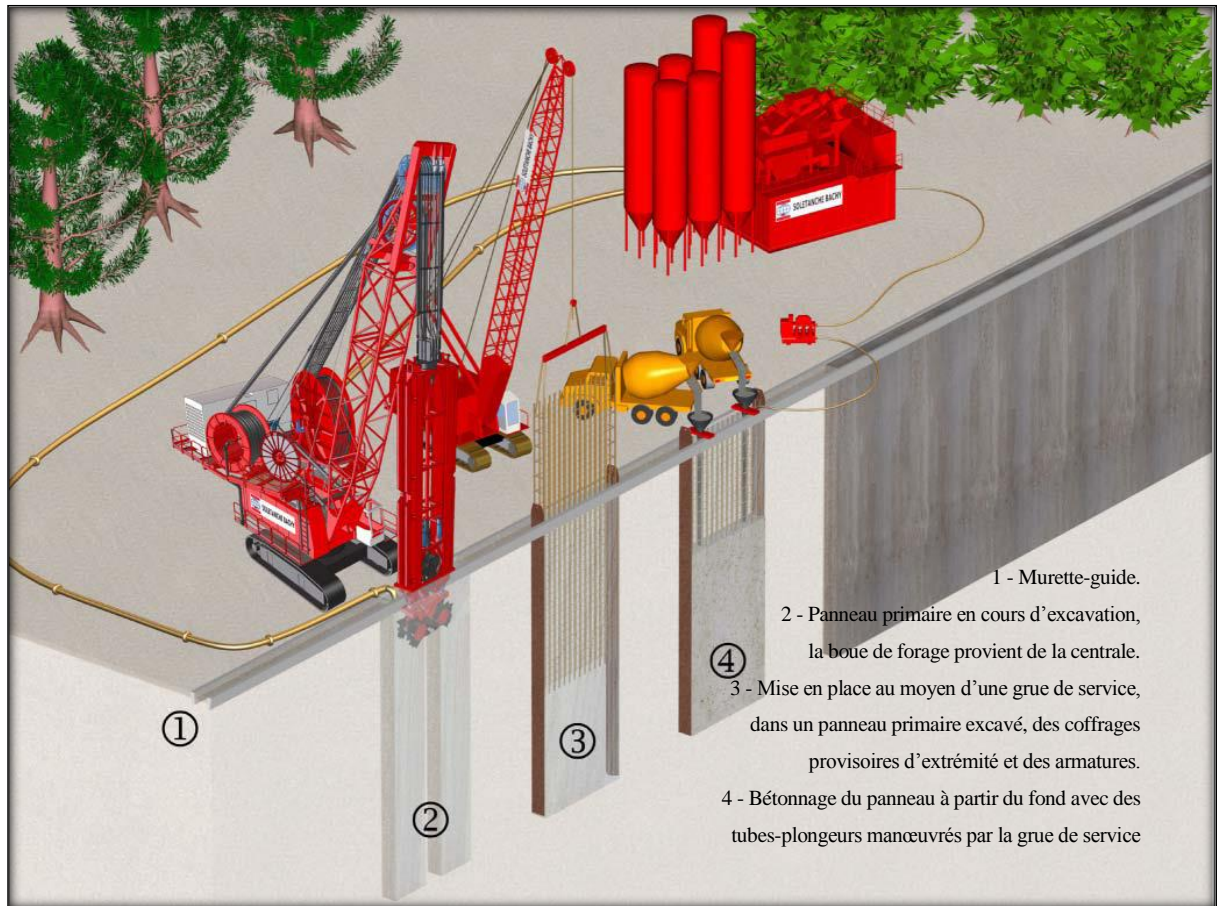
Schéma explicatif de construction de mur paroi moulée
